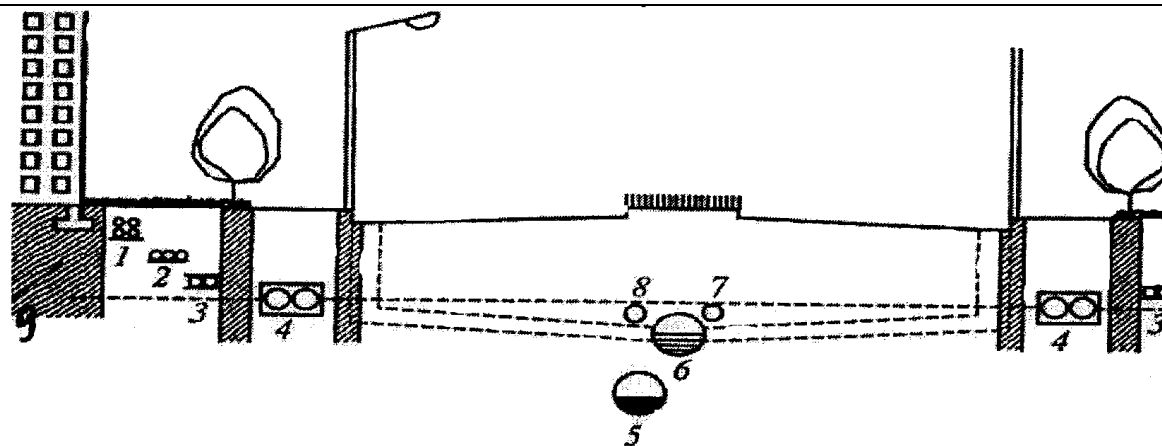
Схема отдельной прокладки инженерных сетей в поперечном профиле улицы: 1 – слаботочные кабели; 2 – силовые кабели; 3 – телефонные кабели; 4 – теплосеть; 5 – канализация; 6 – водосток; 7 – газопровод; 8 – водопровод; 9 – граница зоны промерзания. Подземные инженерные сети прокладывают тремя способами: 1) отдельным, когда каждую коммуникацию прокладывают в грунте, соблюдая санитарно-технические условия размещения независимо от способов прокладки остальных коммуникаций;
